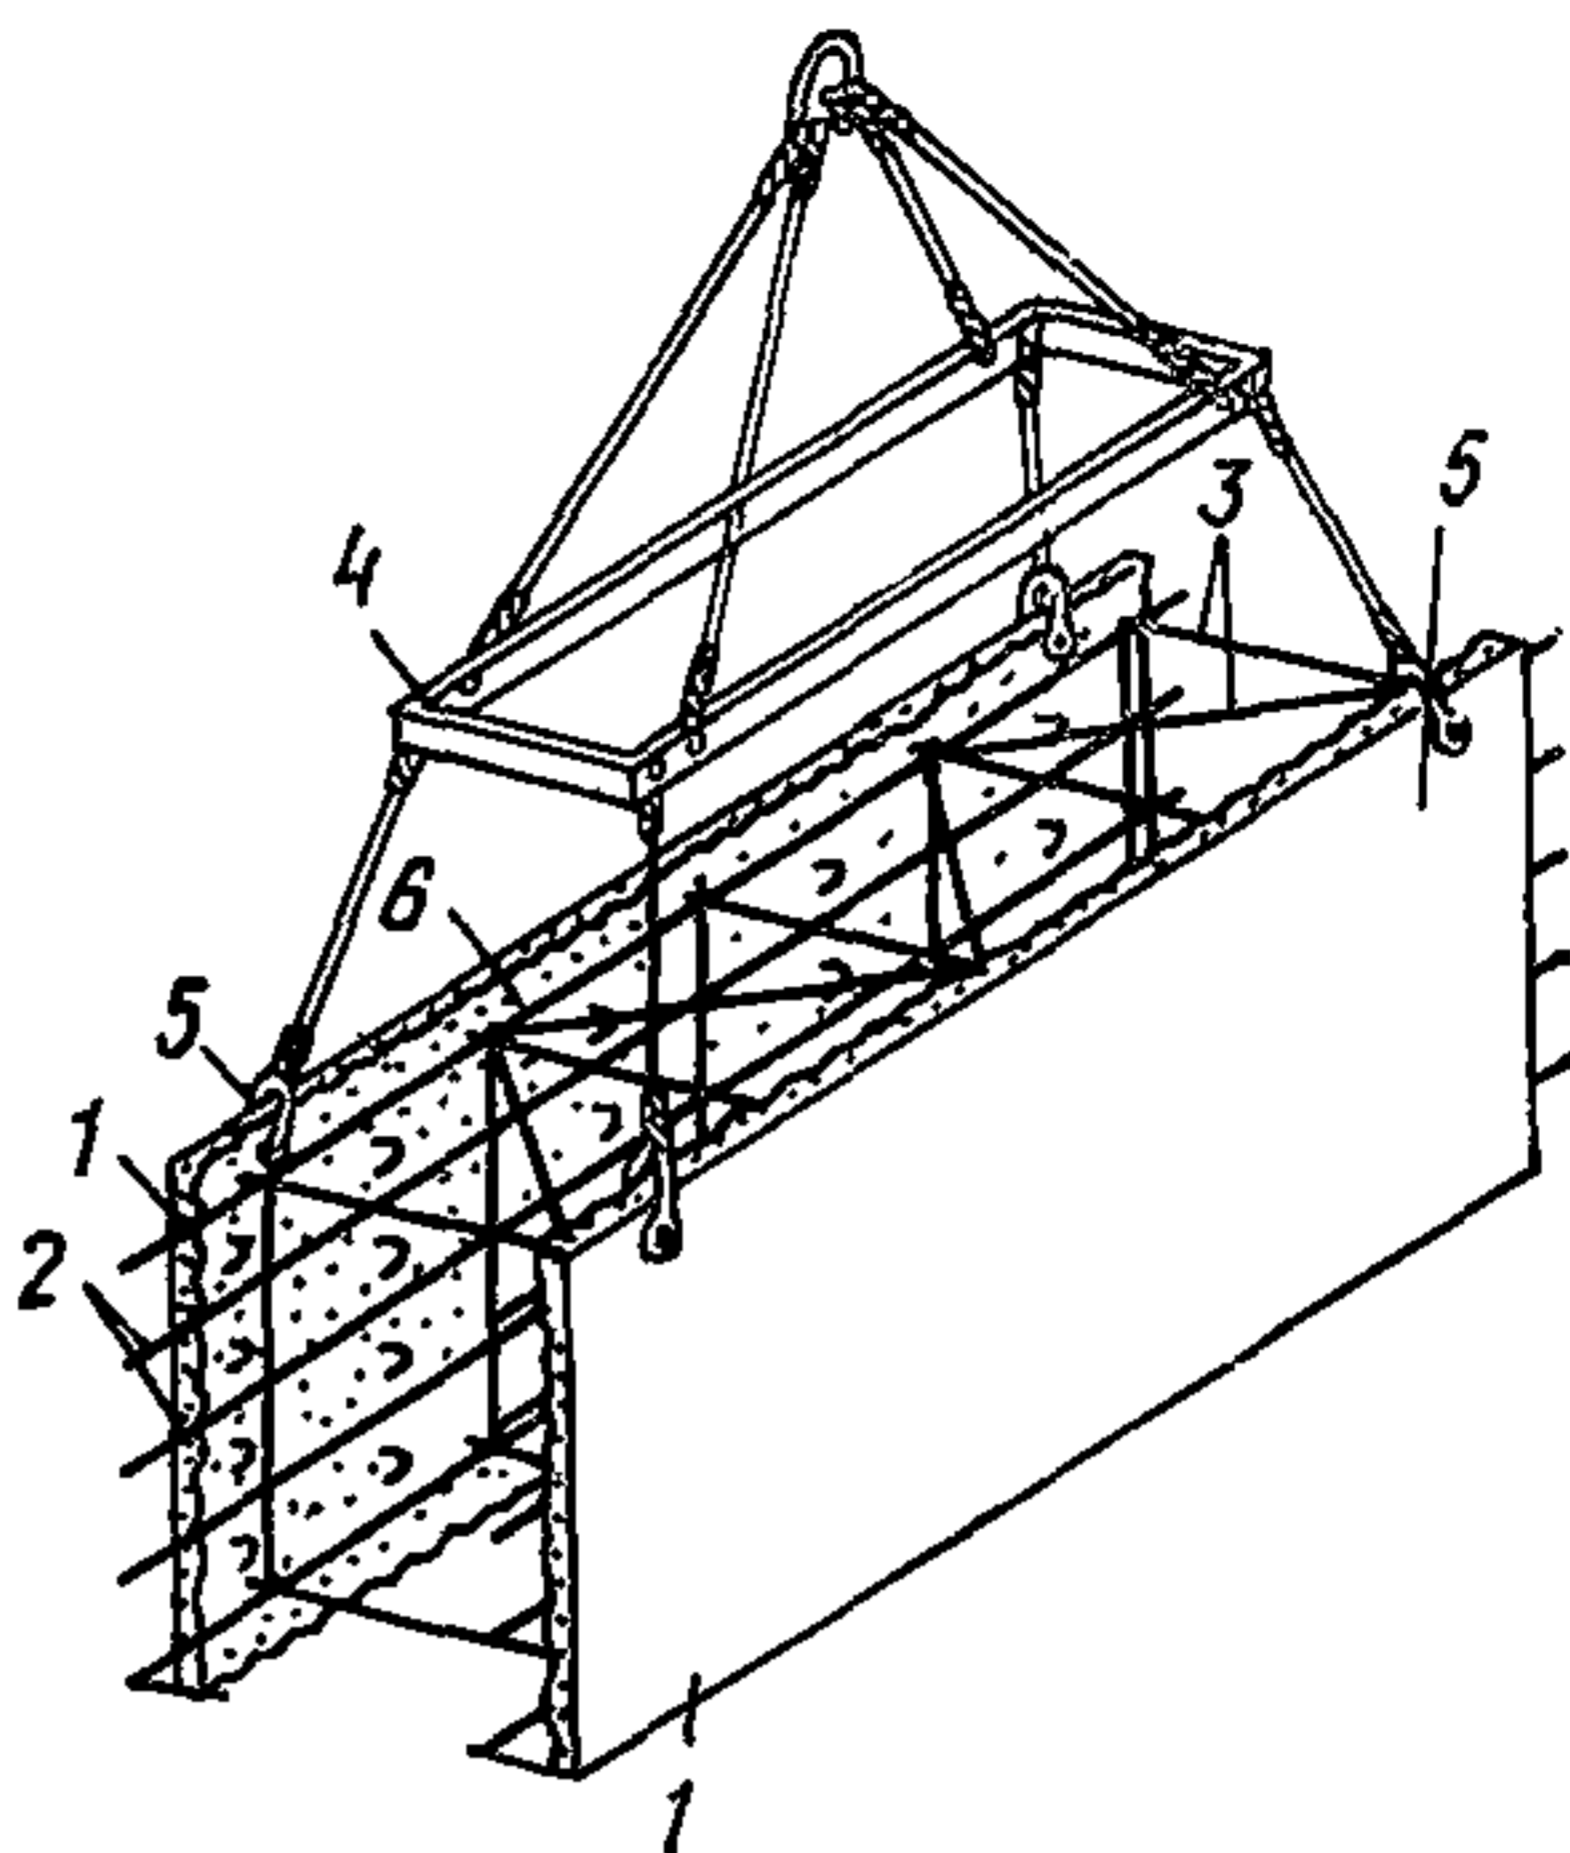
Армоопалубочный блок («чемодан») с использованием плоских опалубочных плит
